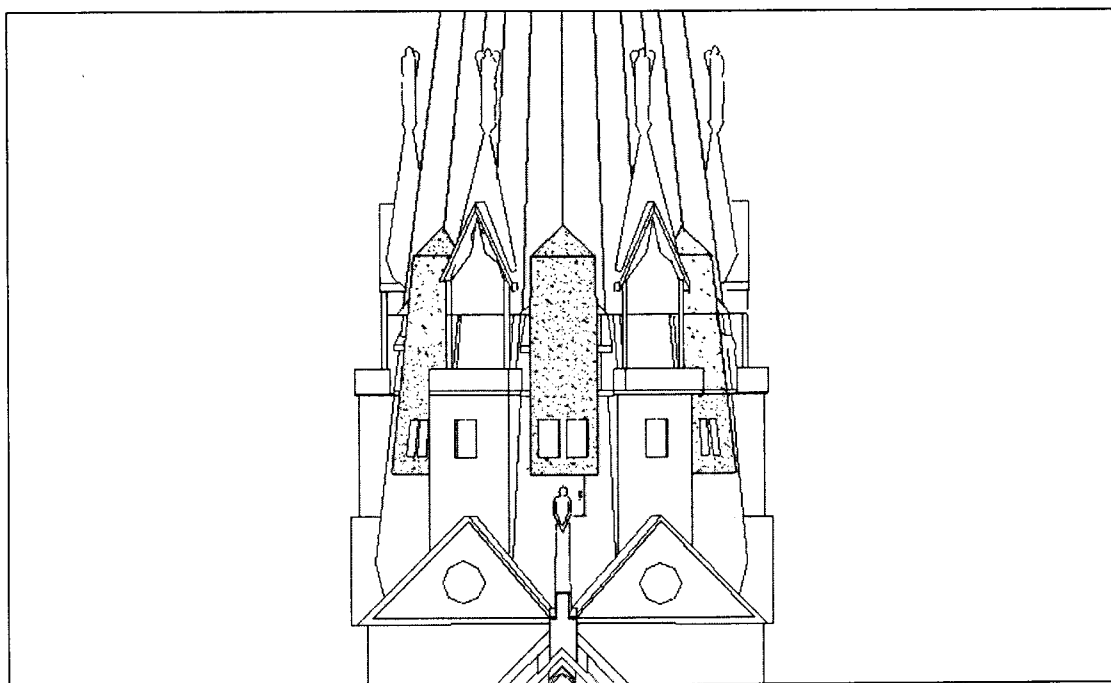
Detalle de pantallas de refuerzo adosadas en la aguja central
